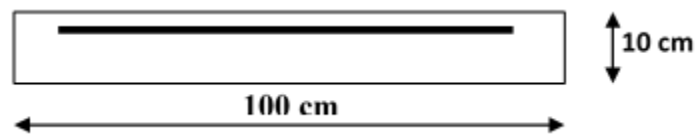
Section théorique pour le ferrailage de l'acrotère
